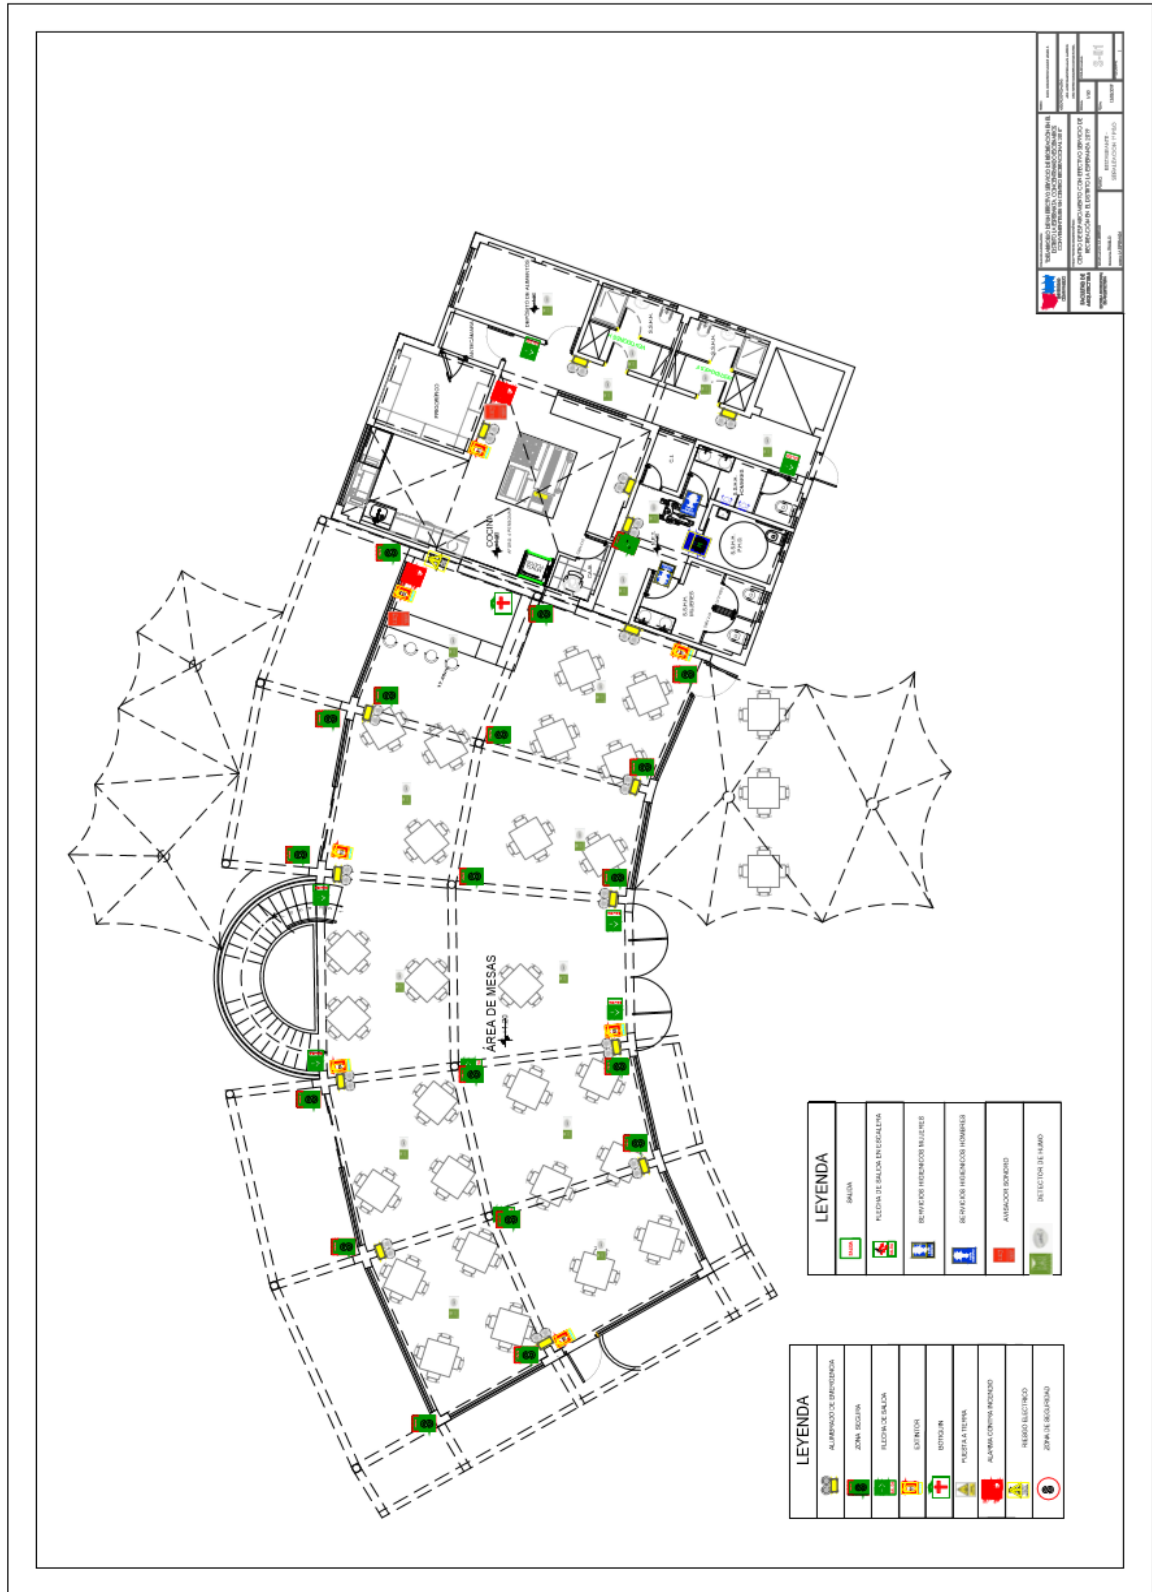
Plano de Señalética Restaurante 1er piso. Elaboración propia.
